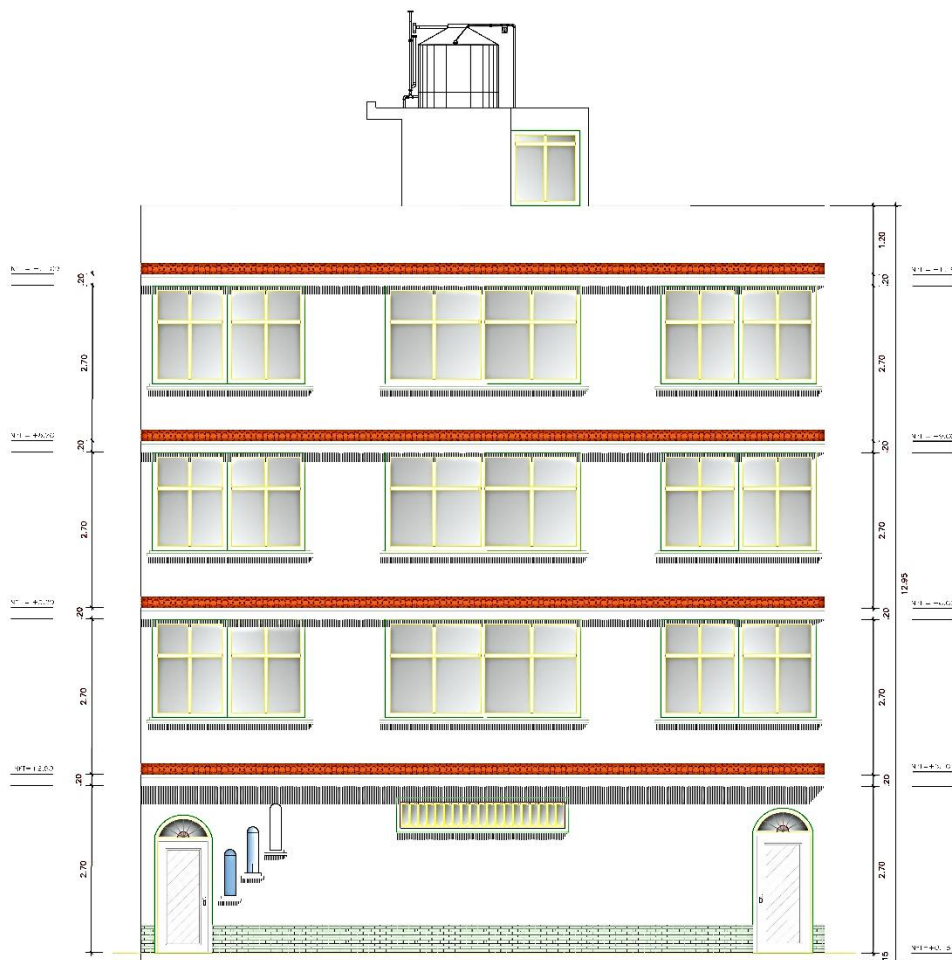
Elevacion de la Edificación - Fuente: Elaboracion Propia
